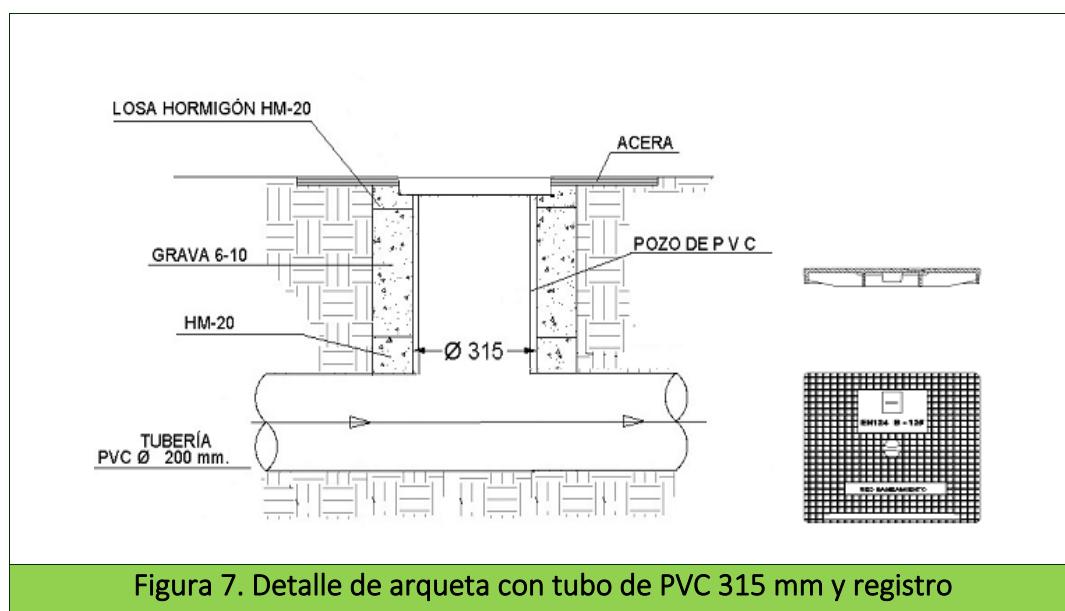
Detalle de arqueta con tubo de PVC 315 mm y registro
